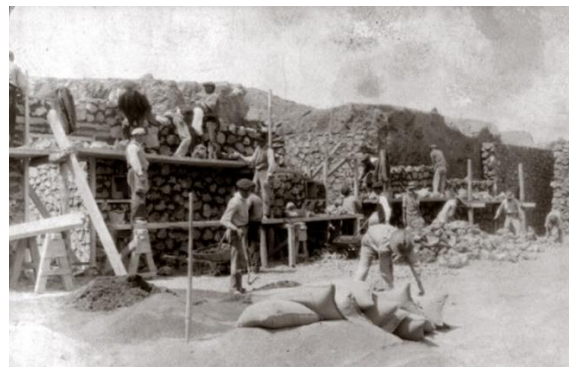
Levantamiento de cerramientos de mampostería. (Fuente: Lorenzo, 2019)
